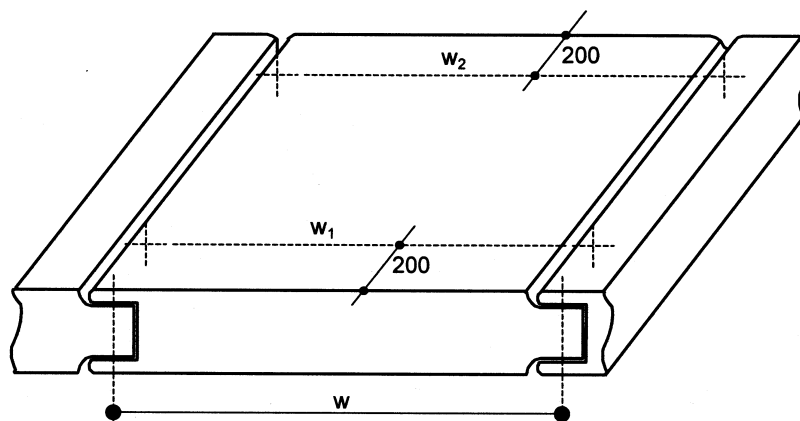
Largeur utile (w) pour un assemblage mâle-femelle
